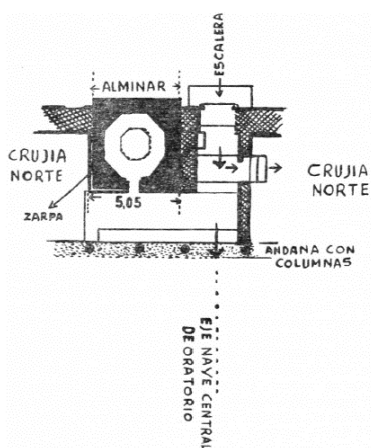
Planta del alminar de Madinat al-Zahra'. Plano de Basilio Pavón, (Pavón Maldonado, 1976).
